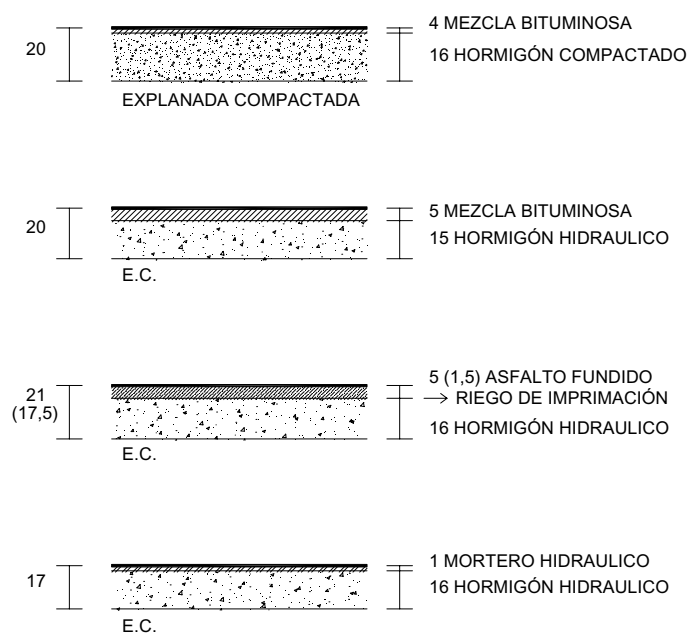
SECCIONES DE FIRME PARA SENDAS BICI (cotas en cm)
